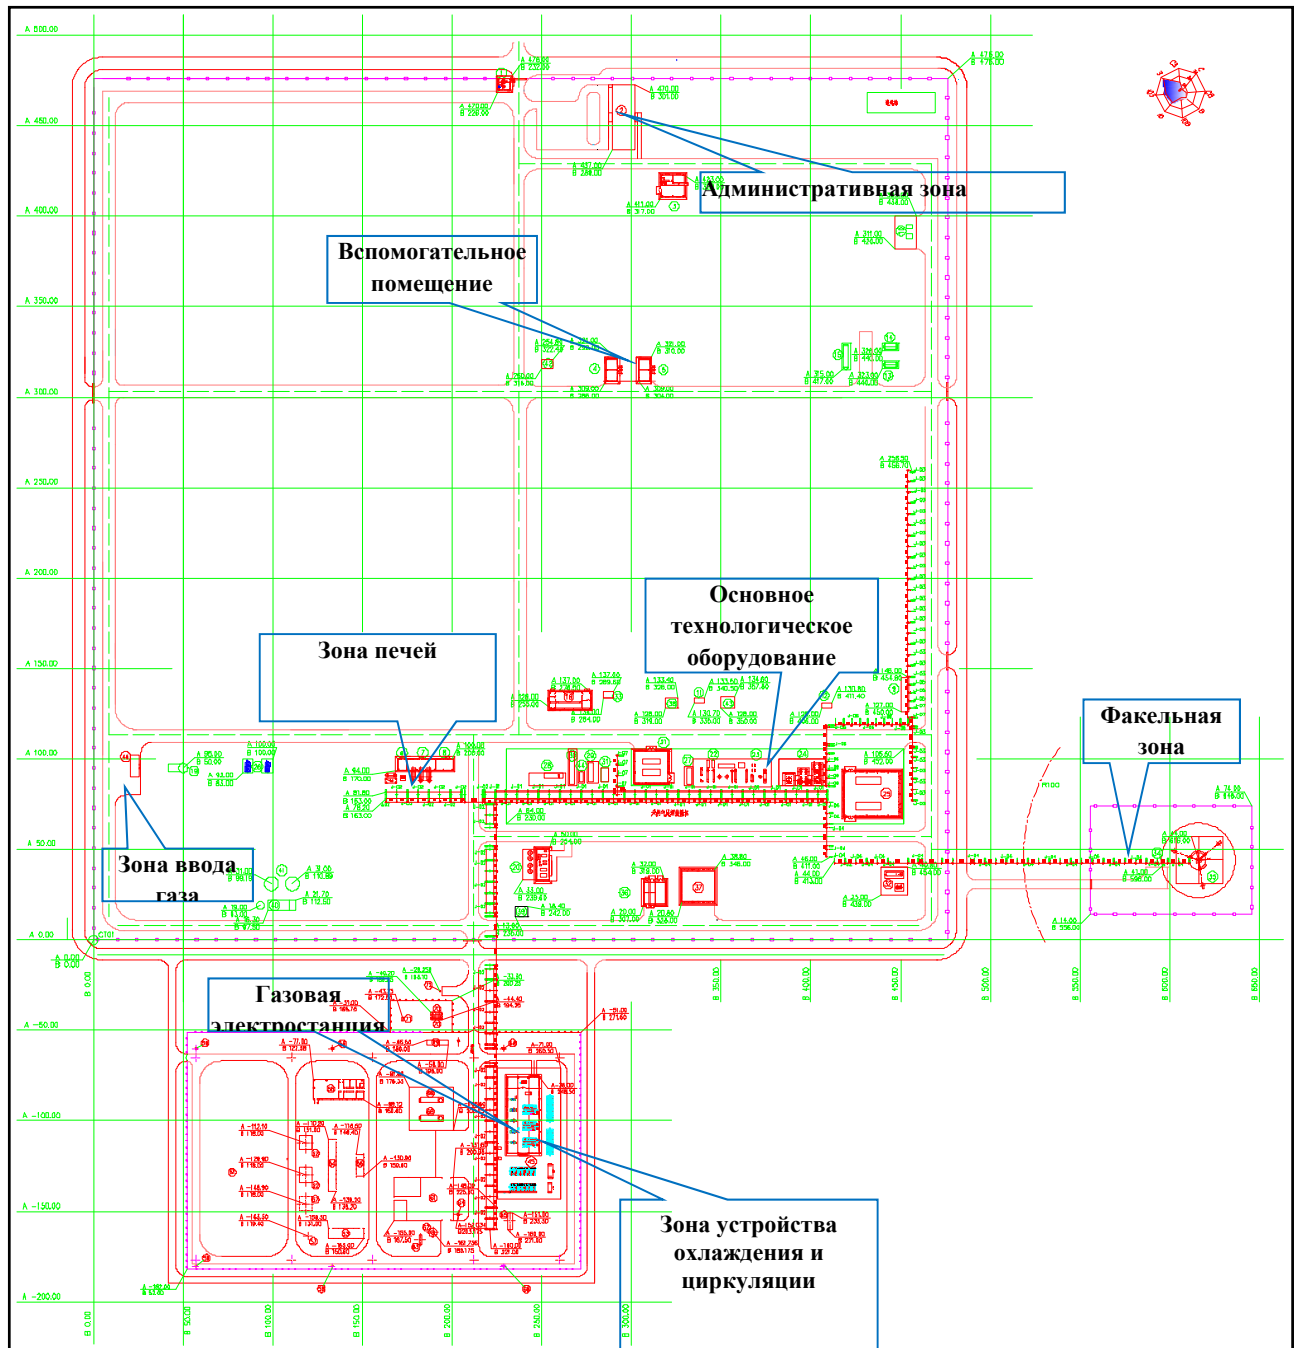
Схема размещения основных сооружений установки подготовки газа
